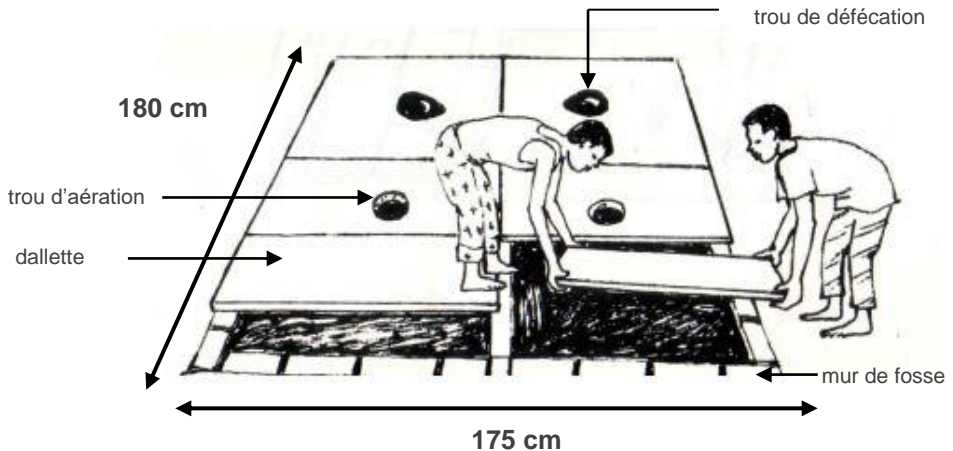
Pose des dallettes sur la fosse d'une latrine VIP
